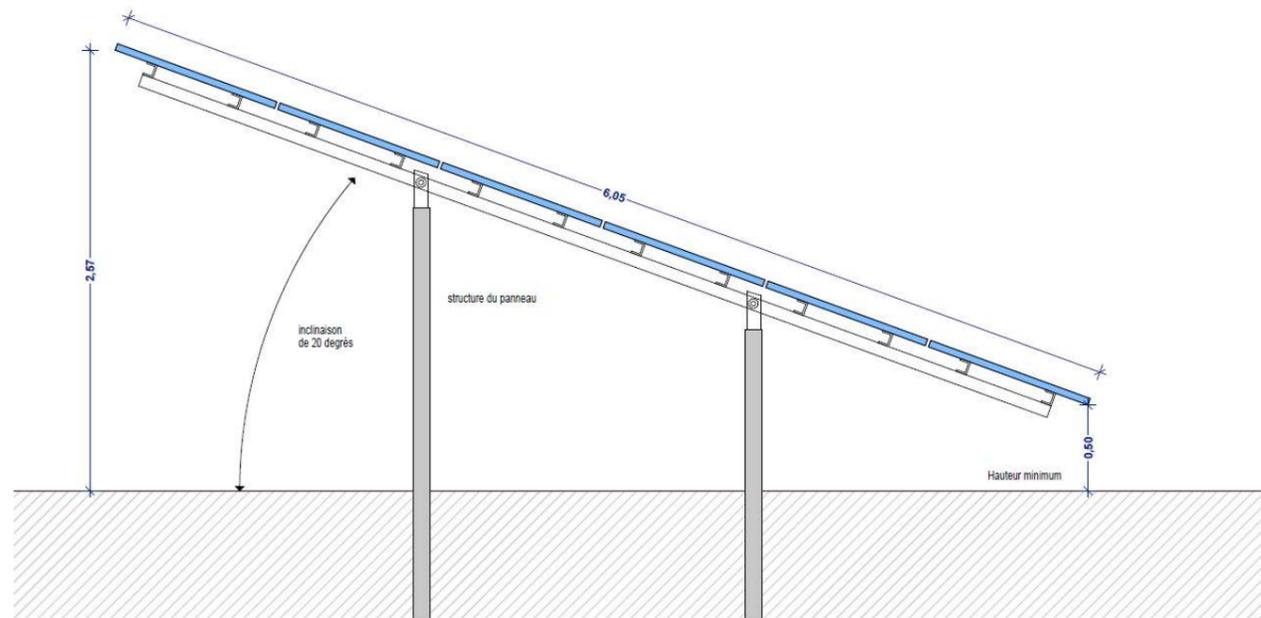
Coupe et plan modèle des structures photovoltaïques
